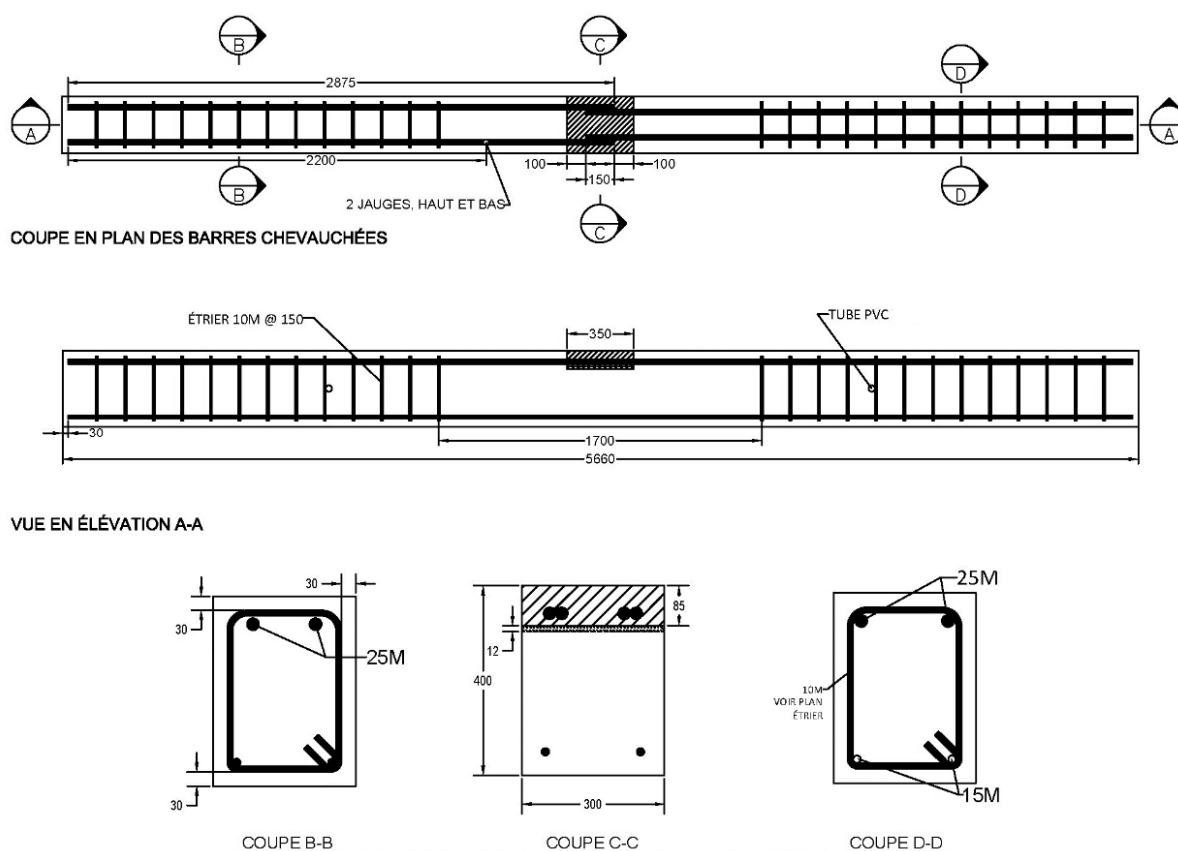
Dimensions et détails d'armature des spécimens de poutres monotoniques
